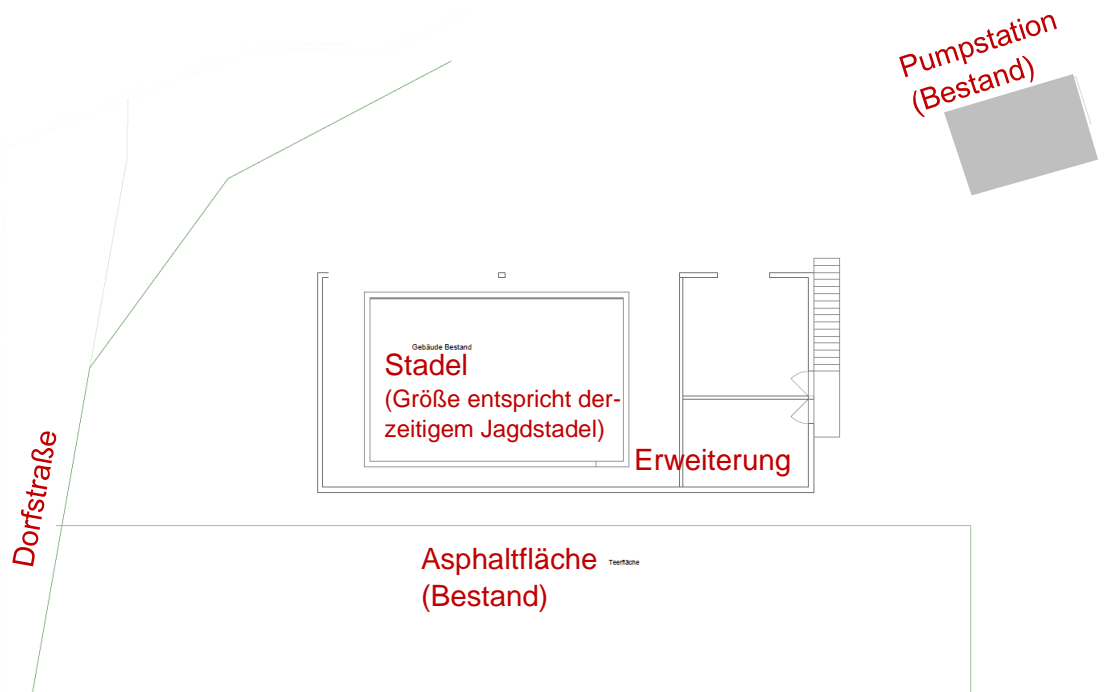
Lageplan Jagd- und Vereinsstadl, Stand 12.09.2025, ohne Maßstab, Quelle: Metall & Gestaltung David Wiedemann, Hechenwang
